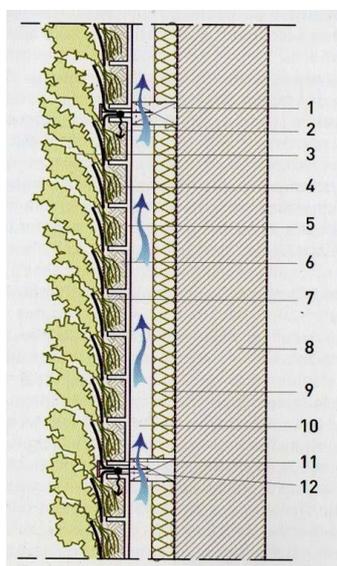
Corte explicativo de uma fachada viva de substrato ligeiro:
